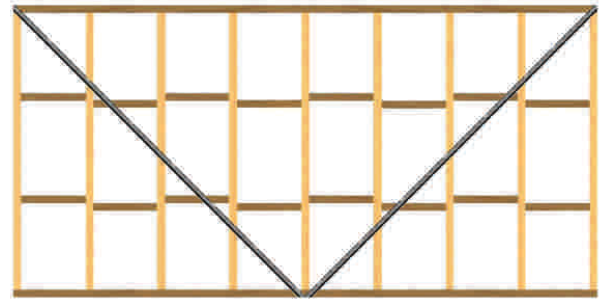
Tabique soportante arriostrado por medio de tensores en barras de acero plano.
